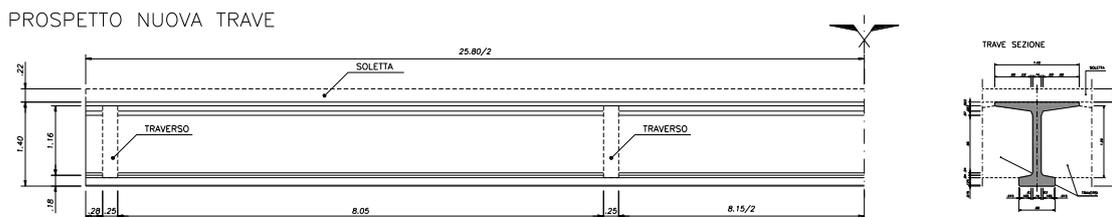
Sezione longitudinale e trasversale delle nuove travi in c.a.p.
